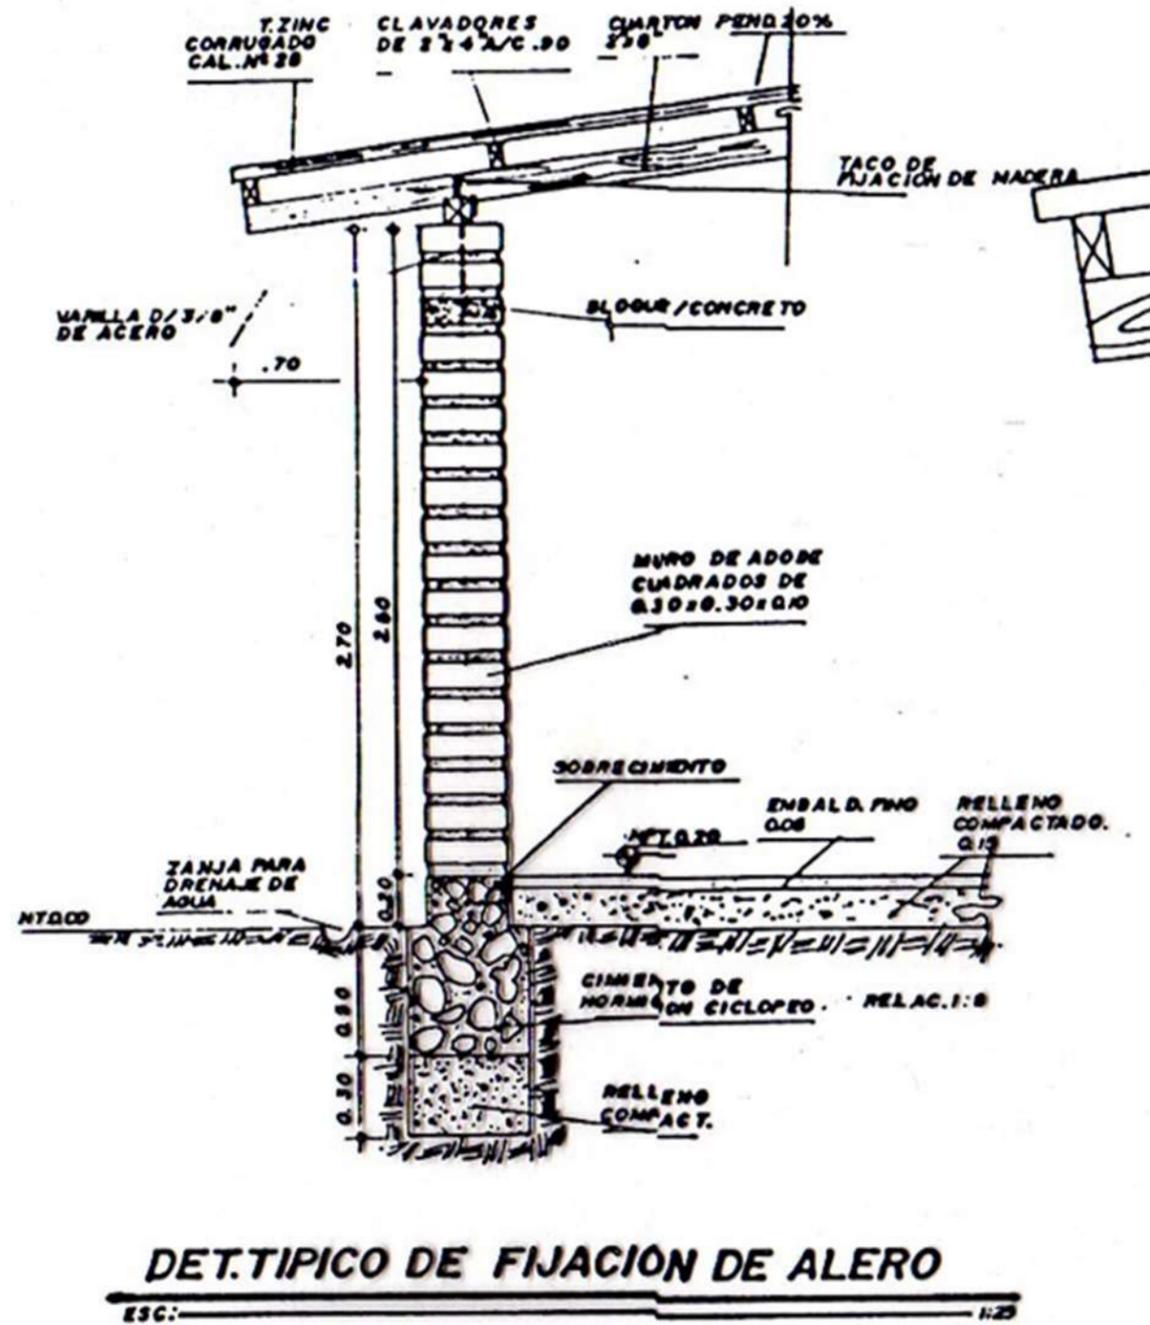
Detalle típico de alero Fuente: adobe.issu.com
